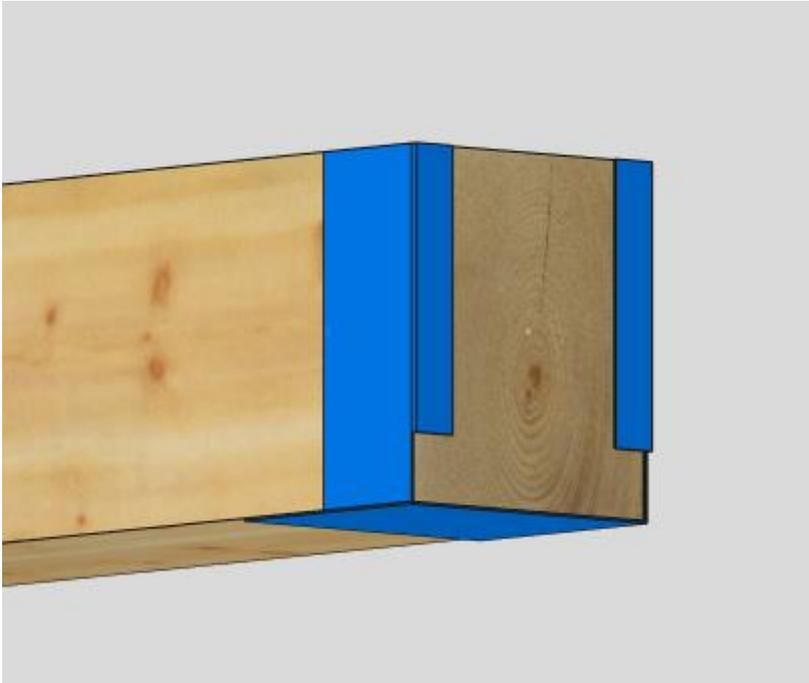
Modelo tipo de estribo con alas interiores en viga.
